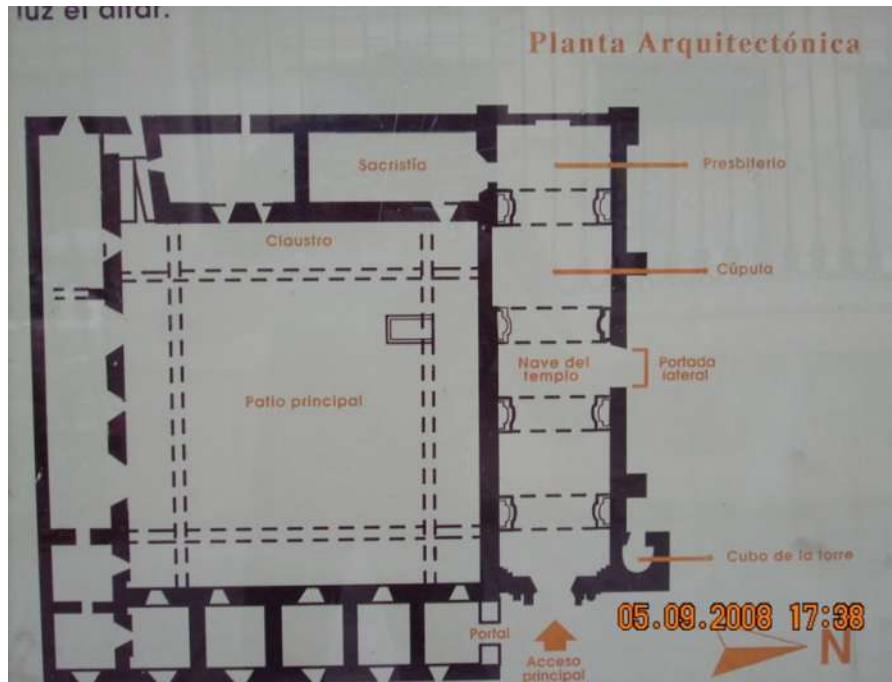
Planta Arquitectónica del Conjunto Conventual de la Merced (O. Segura, 2008).
